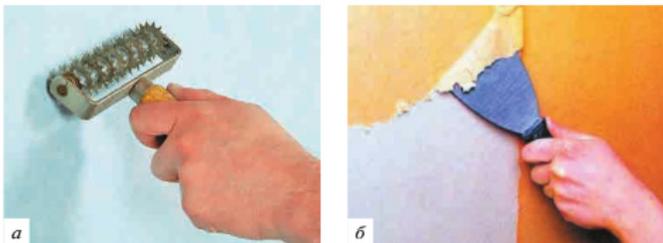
Инструменты и приспособления для снятия старых обоев:
